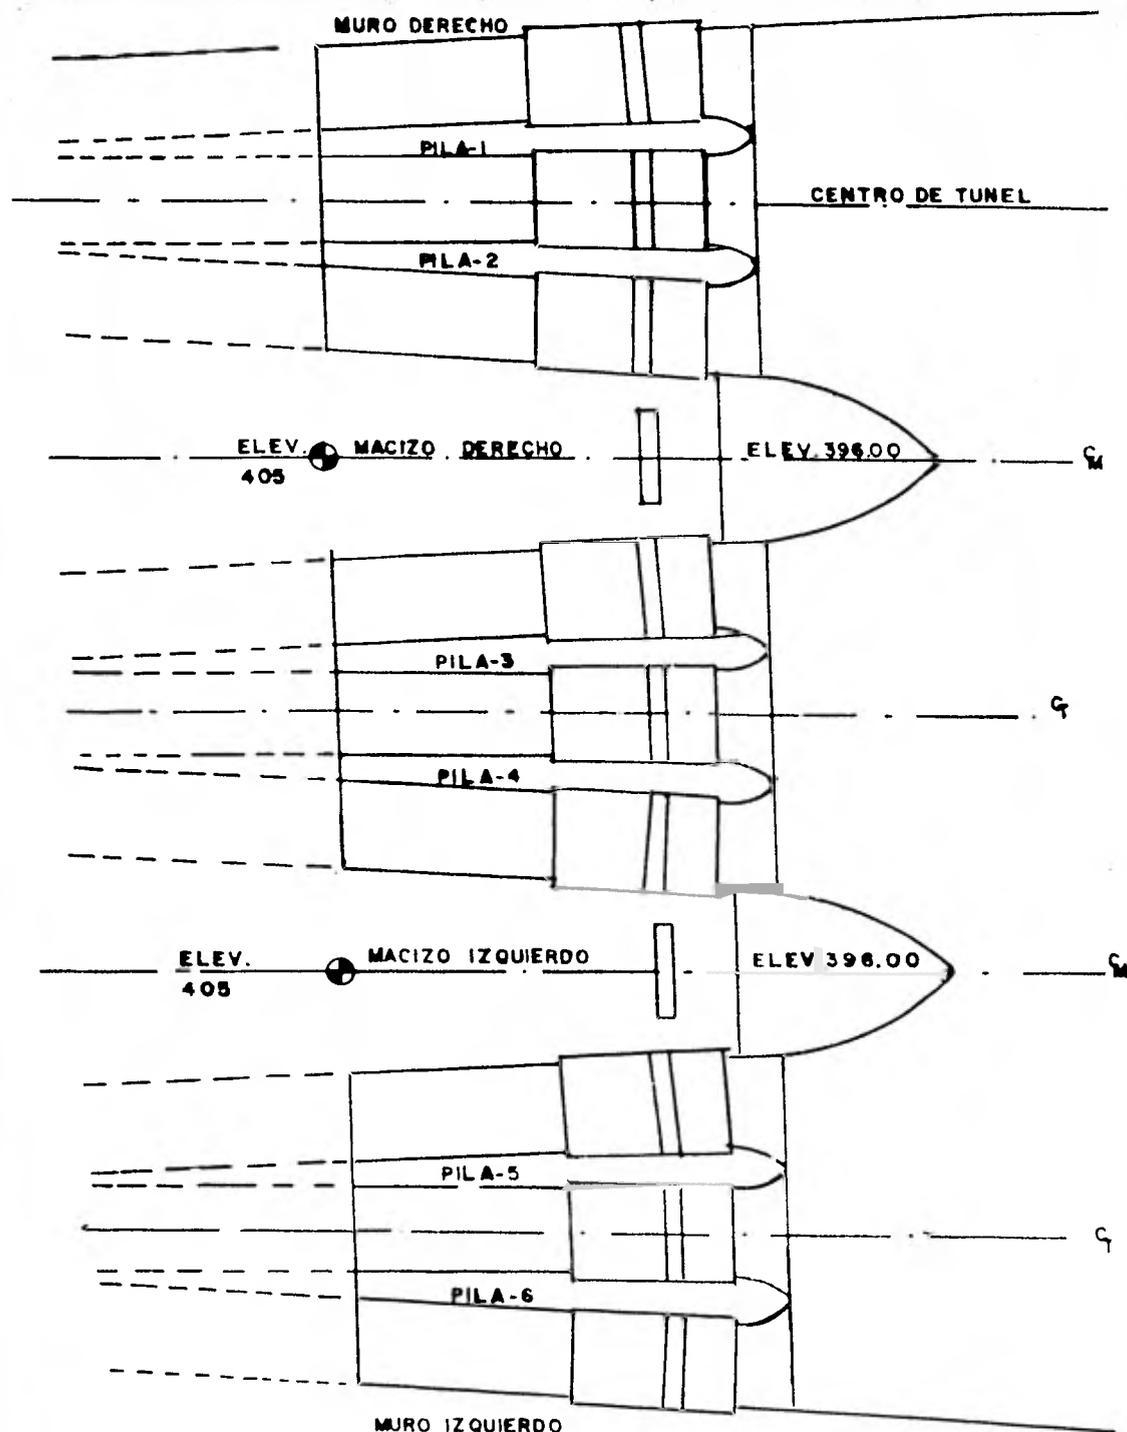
PLANTA DE LA ZONA DE ESTRUCTURA
